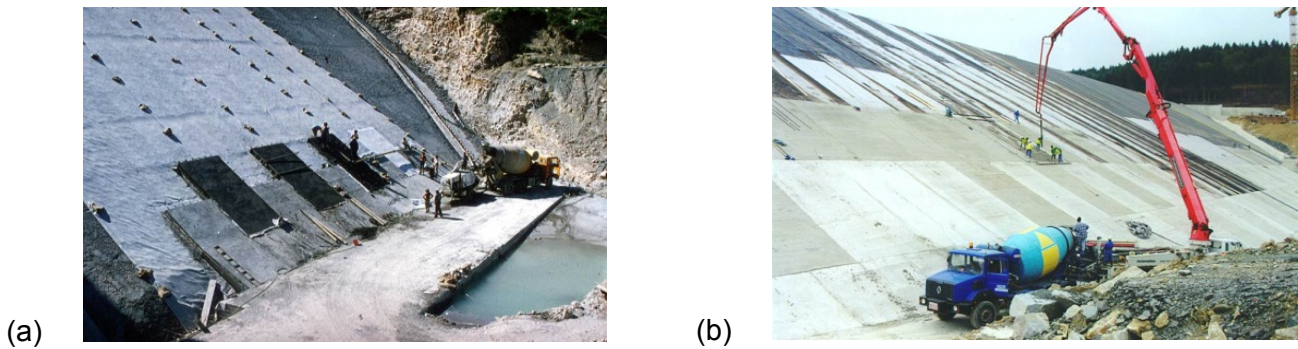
(a) Barrage de Bovilla pendant la mise en place de la protection en béton. (b) Barrage de la Galaube pendant la mise en place de la protection en béton.
